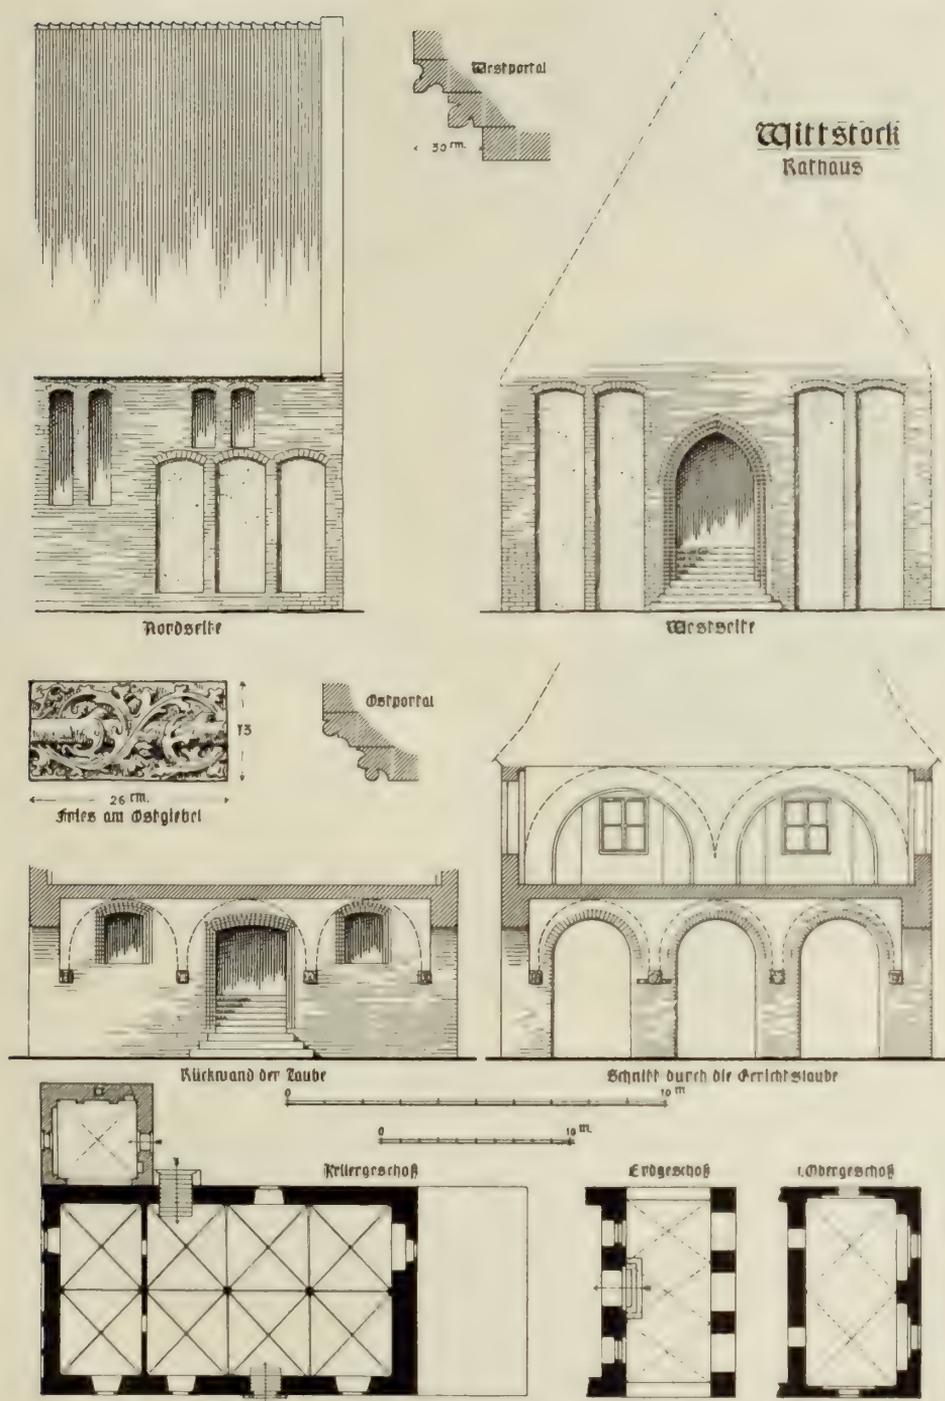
Wittstock. Grundrisse, Ansichten und Schnitte des Rathauses vor dem Umbau.
